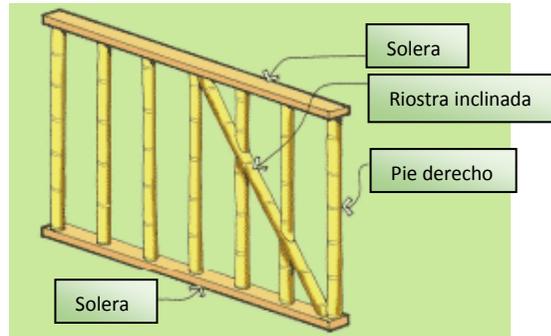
Muro arriostrado. Estos llevan soleras en la parte inferior y posterior.
